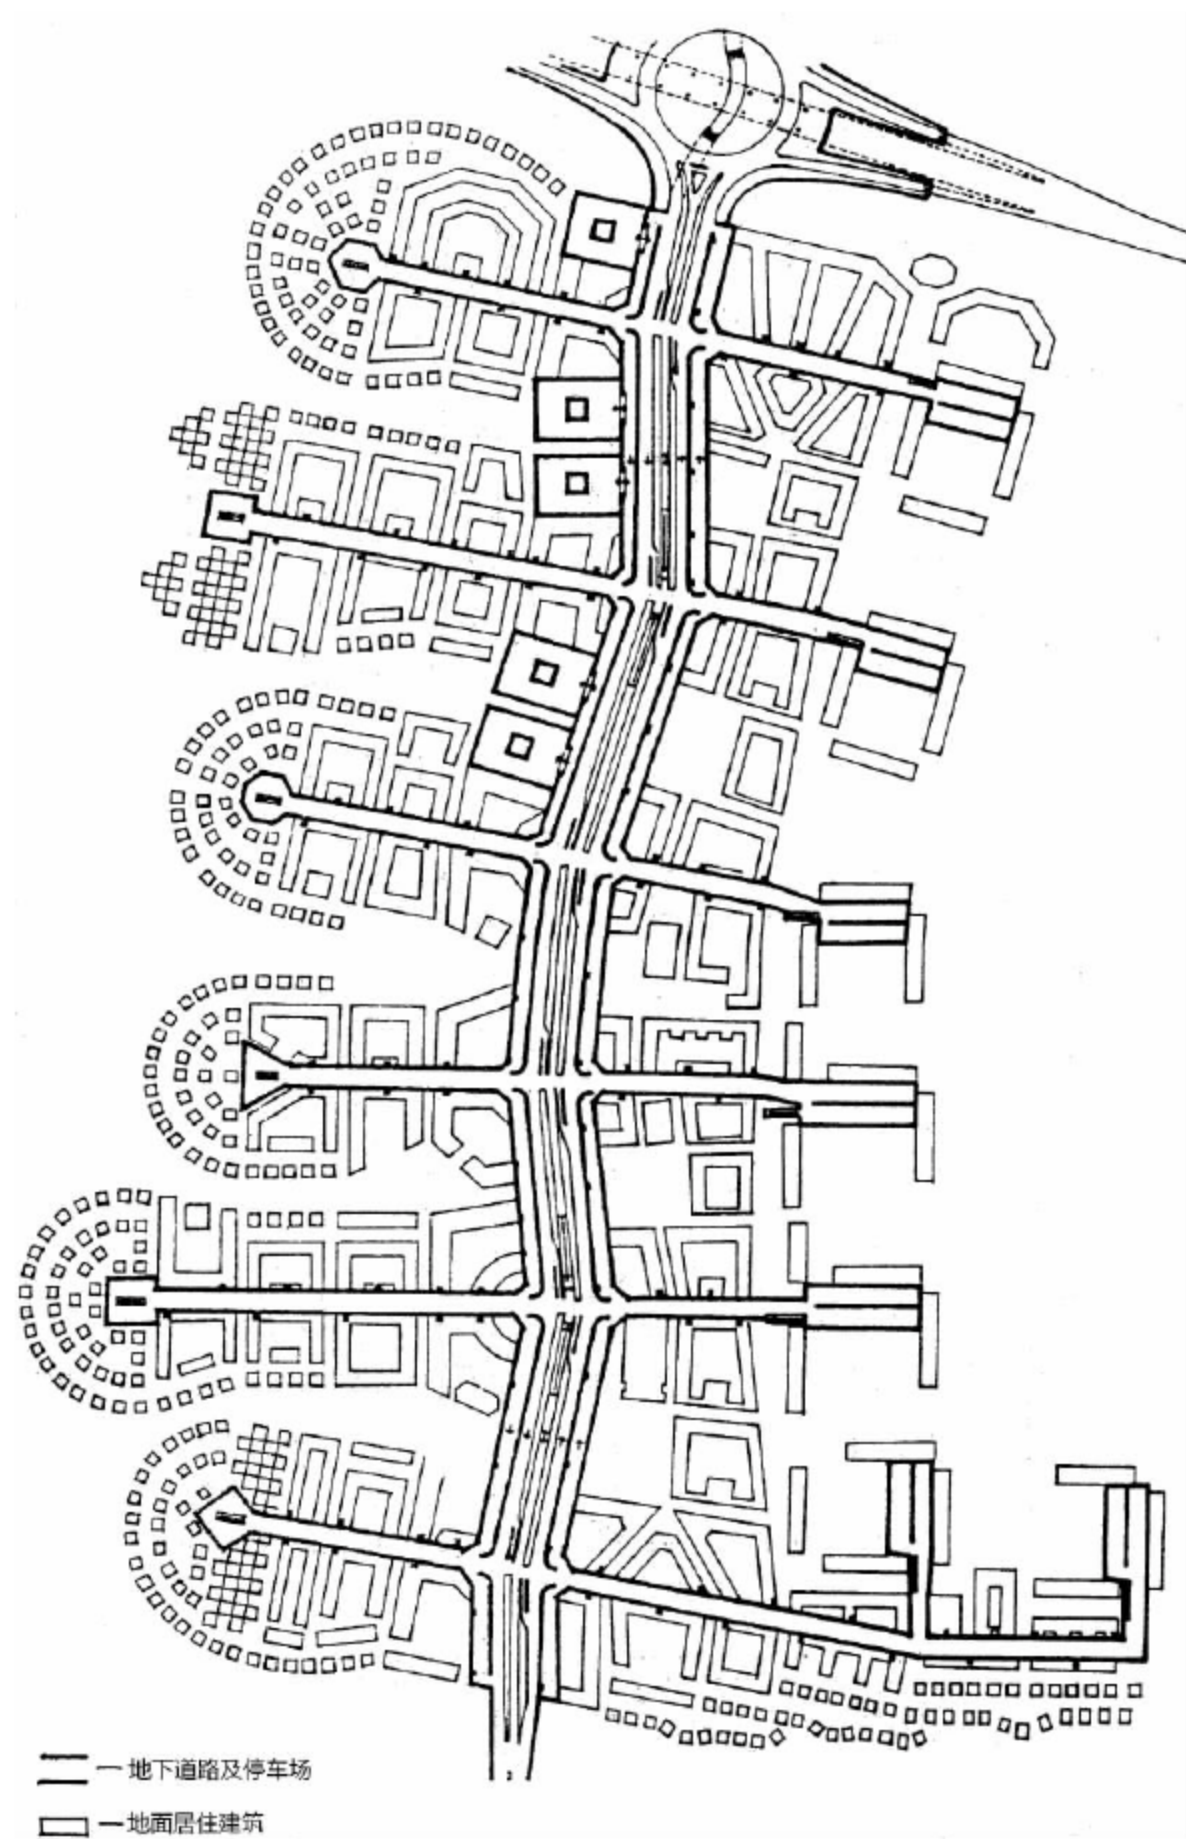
林德堡城居住区“双层城镇”规划地下层平面图
